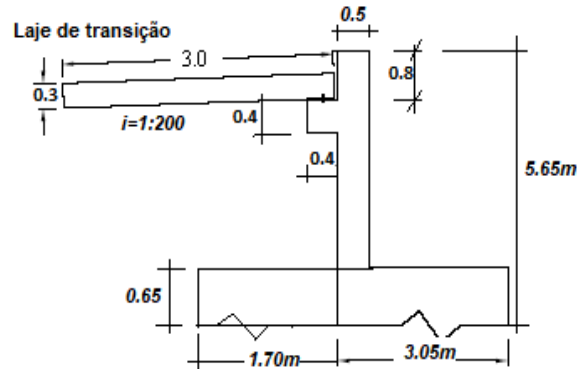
Detalhes da disposição da laje de transição no encontro. Fonte (Autor)
